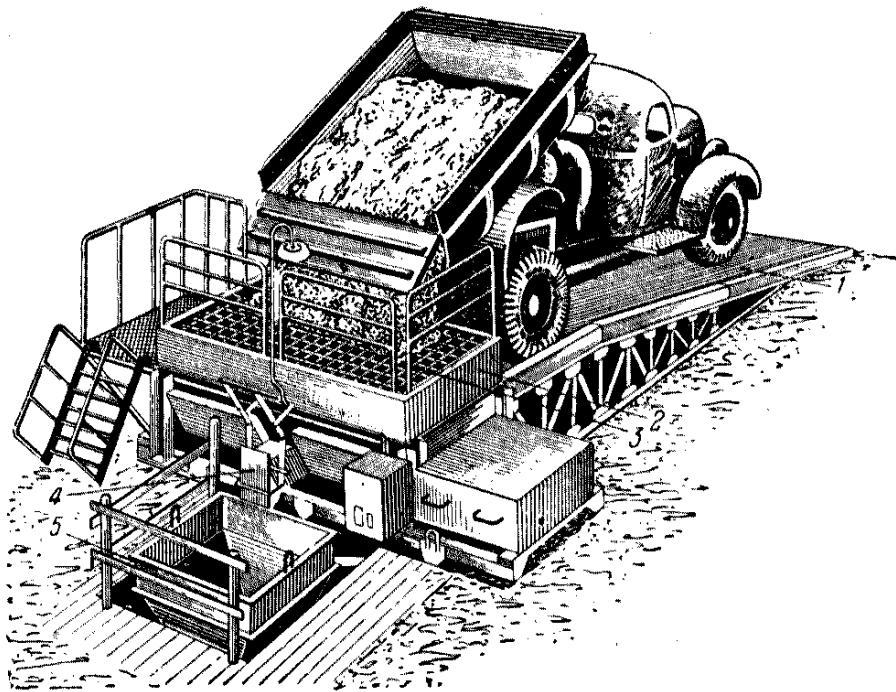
Установка приема, перемешивания и выдачи растворной смеси на строительной площадке
